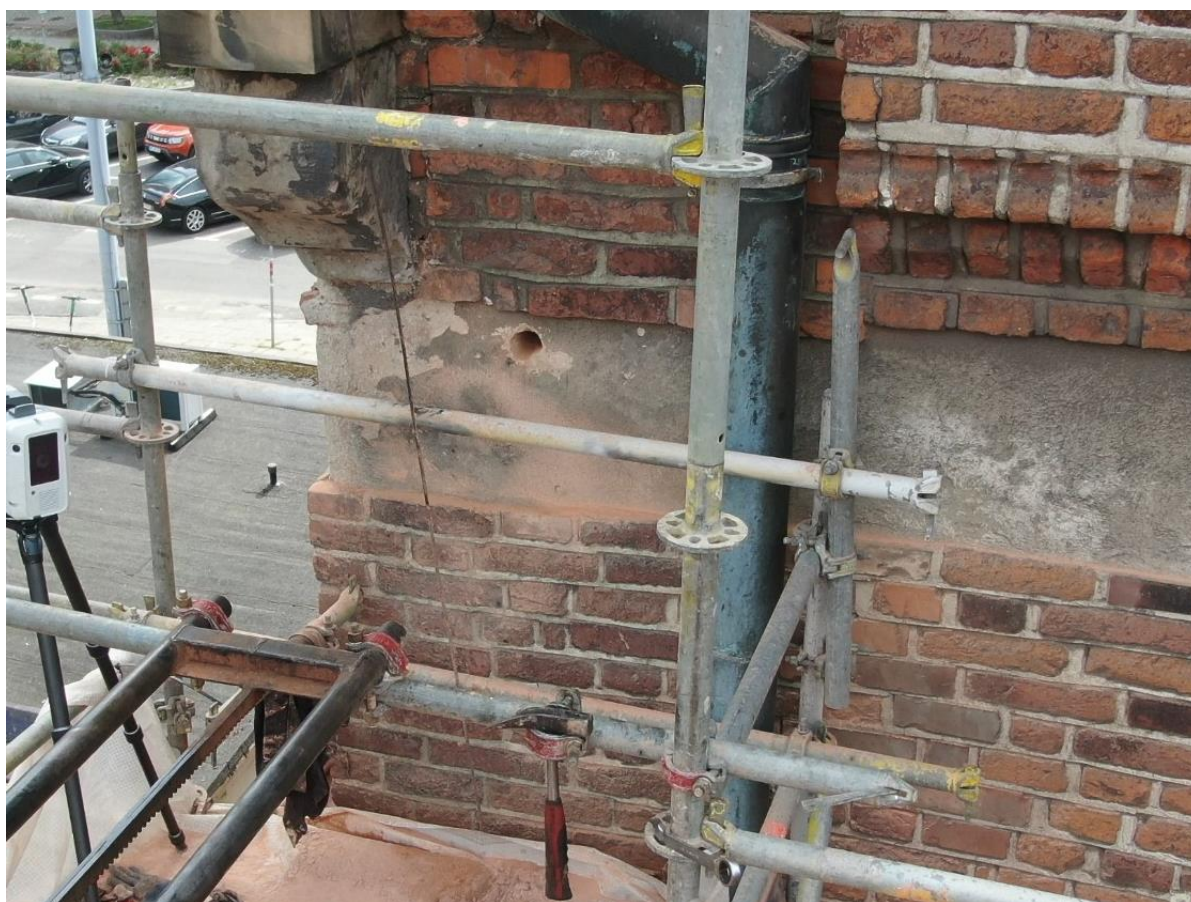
Wykonywanie odwiertu w strefie rdzeniowej muru
